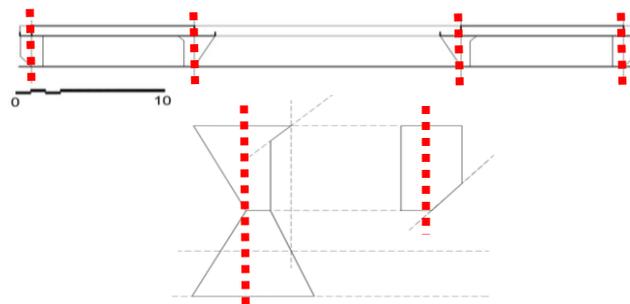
O primeiro Ginásio Estadual de Guarulhos, corte esquemático dos pilares.
